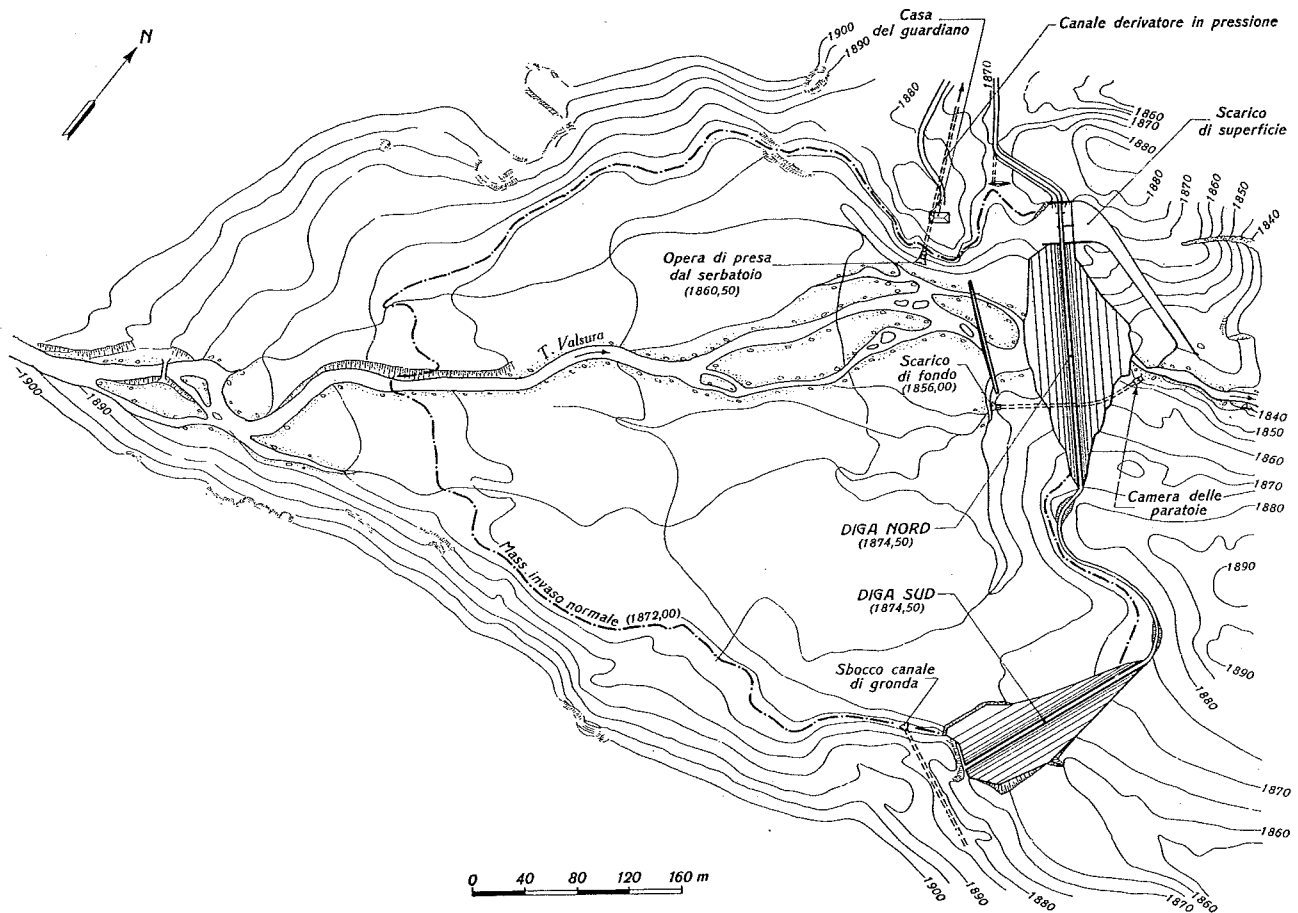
Planimetria generale dell'invaso con le due dighe.
